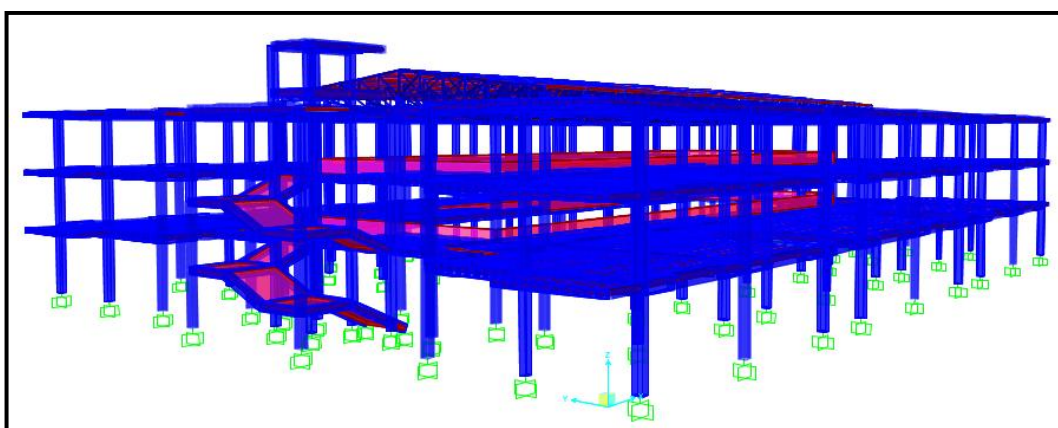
1. Estructura UDO Cantaura (Modelada en Sap2000).
